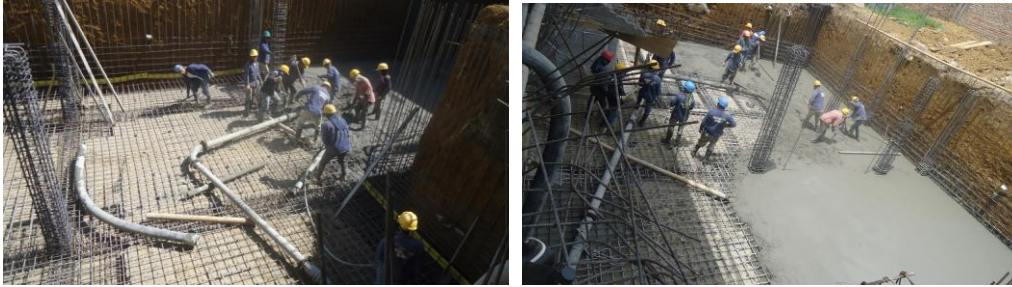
FUNDICIÓN LOSA DE CIMENTACIÓN.
